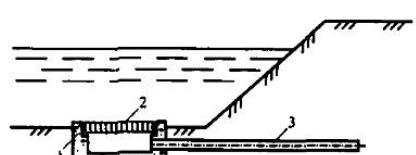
Водопренимное устройство донного типа: 1 - железобетонный колодец; 2 - съемная решетка; 3 - самотечный водовод
